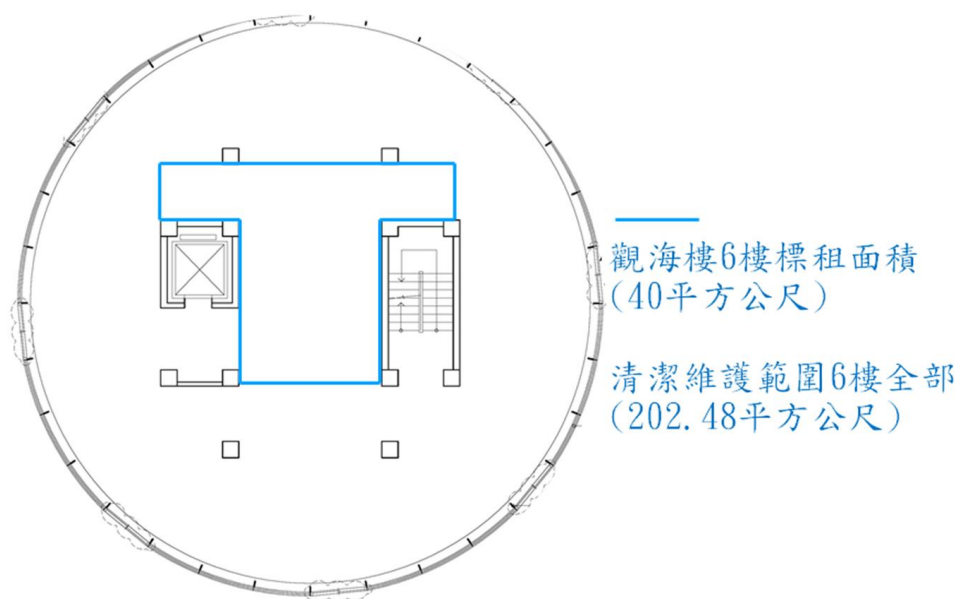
觀海樓 6 樓平面圖(備註:以上平面圖僅供參考,實際尺寸依建築現況為主)
